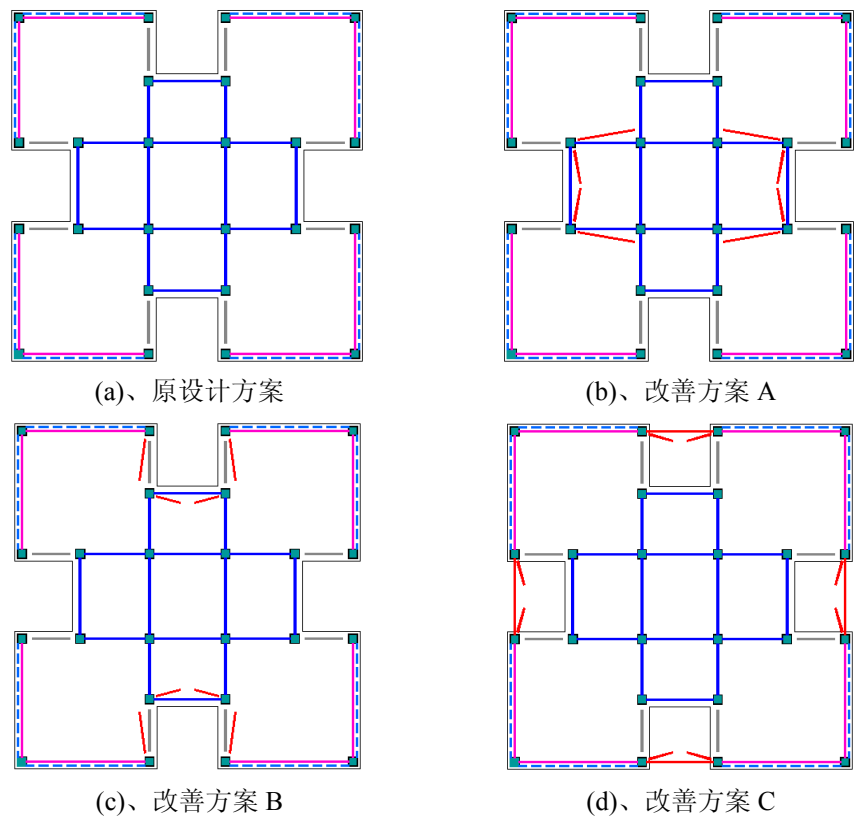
中钢集团总部大楼之原设计与改善方案平面示意图
